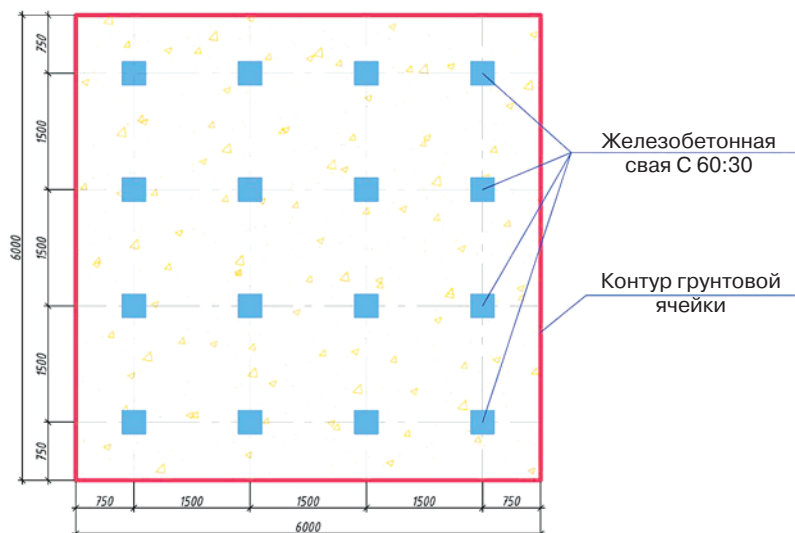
Схема армированной ячейки грунта вертикальными железобетонными элементами для решения задачи по методике СП 22.13330.2016
